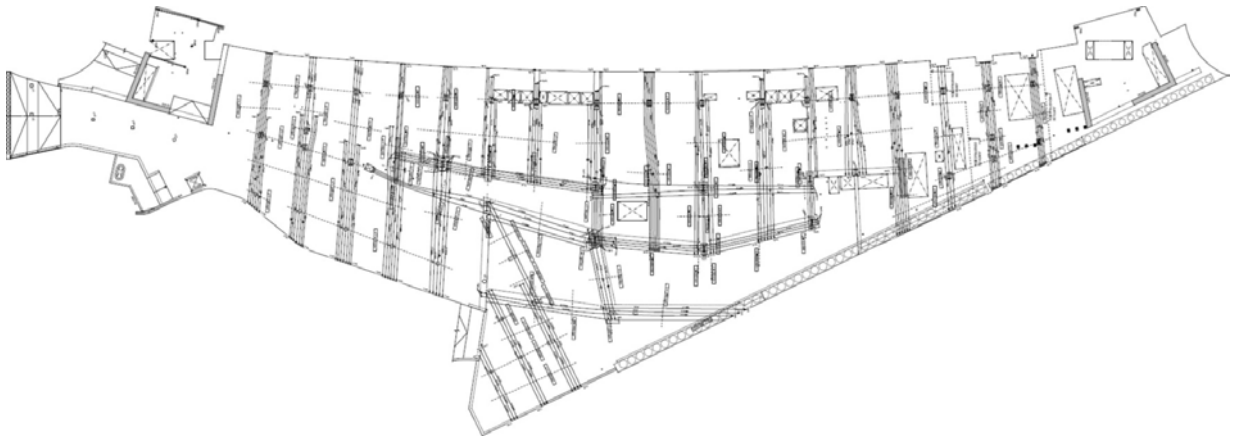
Distribución de cables de pretensado en losa de Planta Primera.
